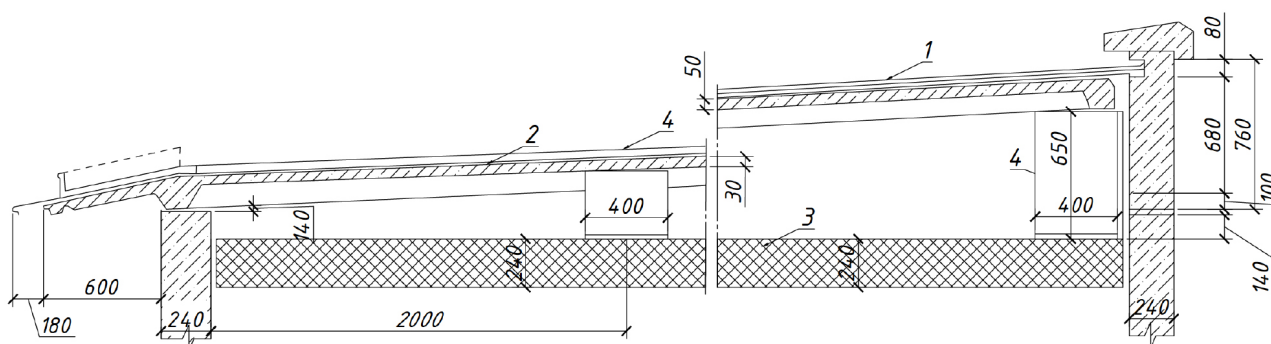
Конструкция вентилируемой крыши дома серии Г-2:
